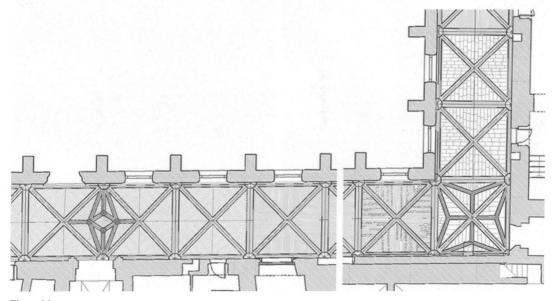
Despiece de plementería en distintas bóvedas, planta (plano de Eduardo Barceló 2007)
